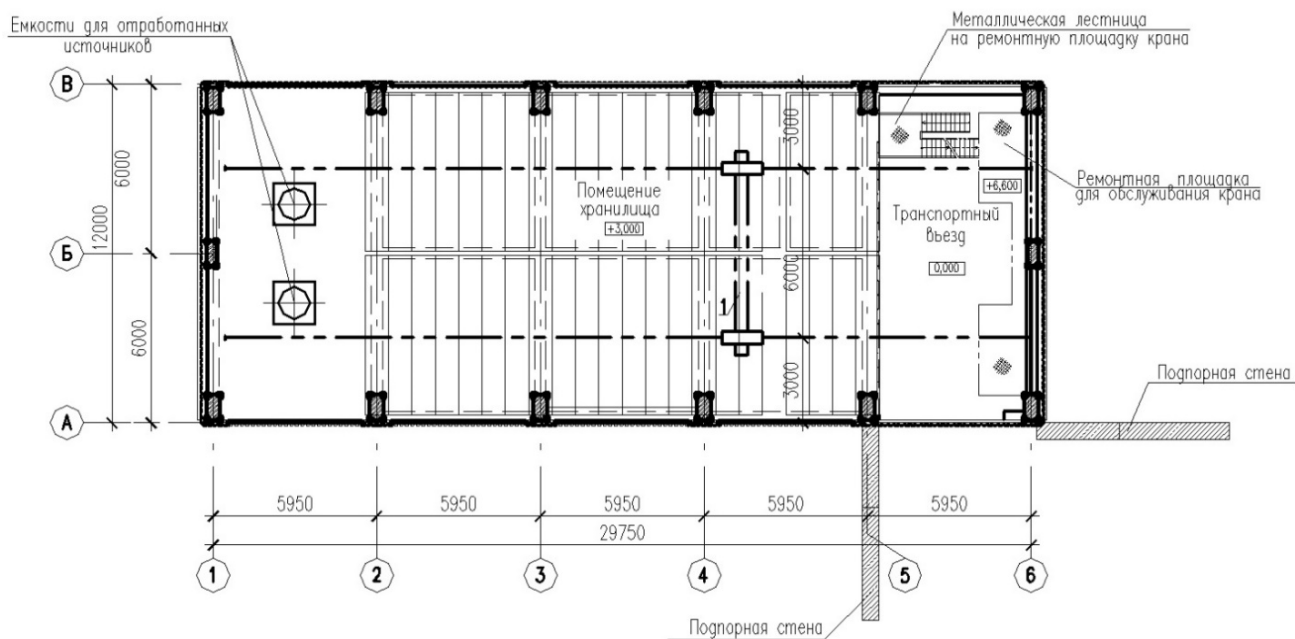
Схематичный план ХТРО П1
